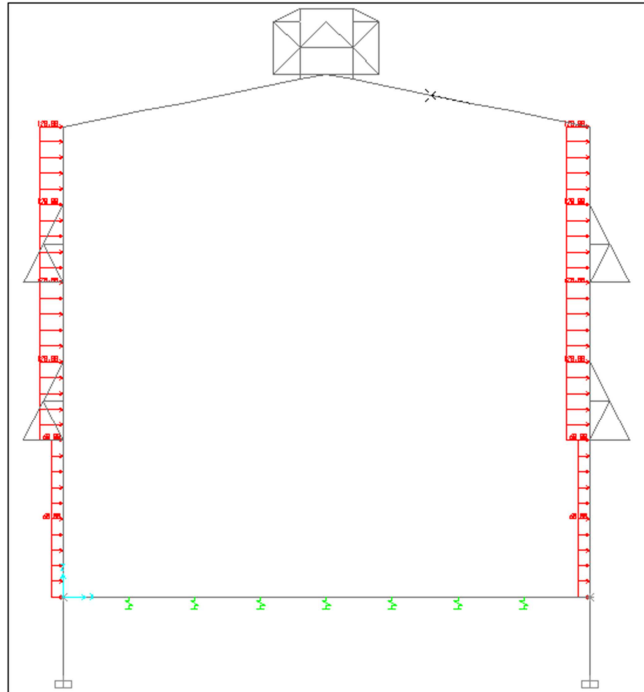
Carga de Viento en eje X (V_x) aplicada a la forma estructural, sección transversal.
